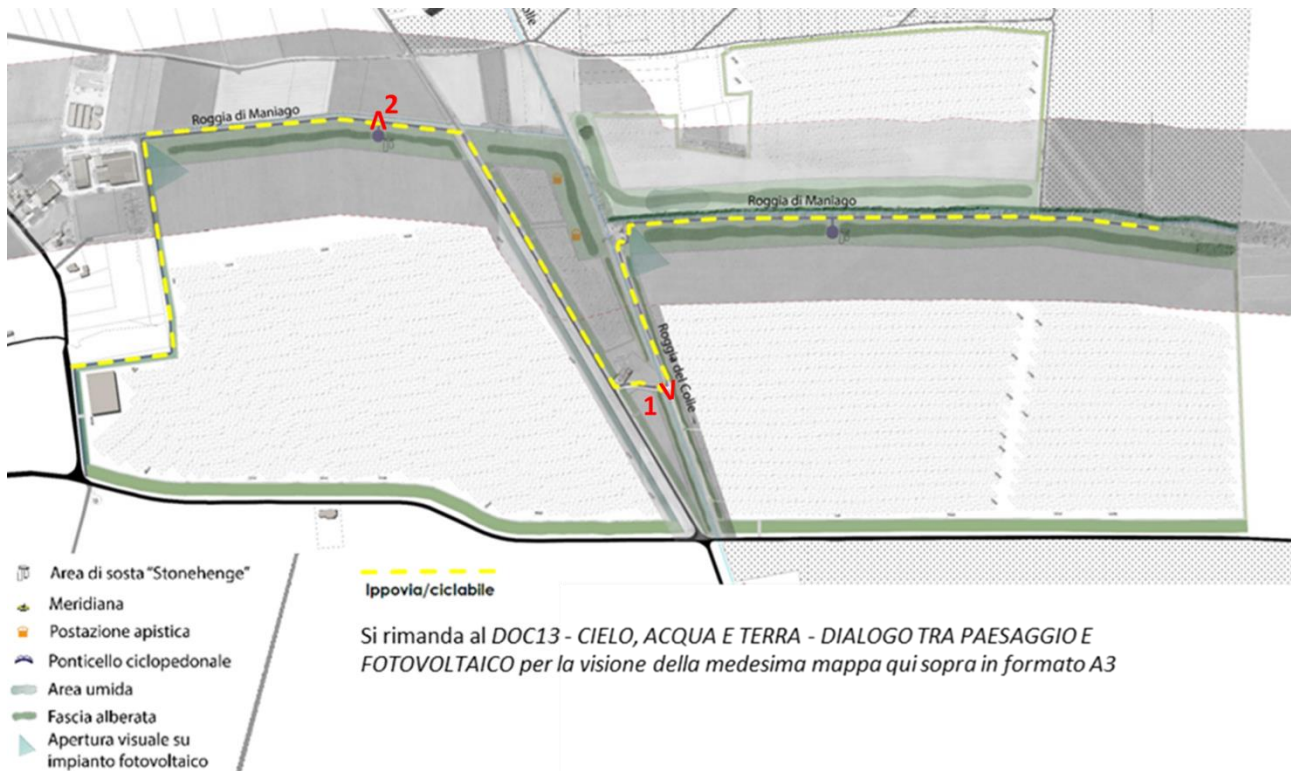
planimetria con indicazione della fascia di rispetto dei 150 m e punti di presa fotografici fotoinserimenti riportati a seguito
